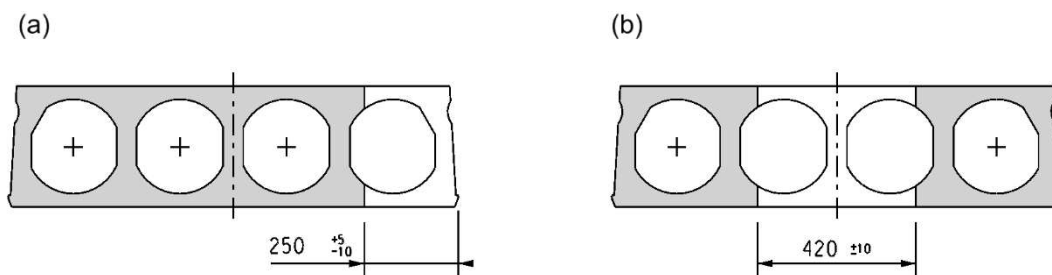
Przekroje poprzeczne płyt SP20 (SP22) w miejscach wycięć:
